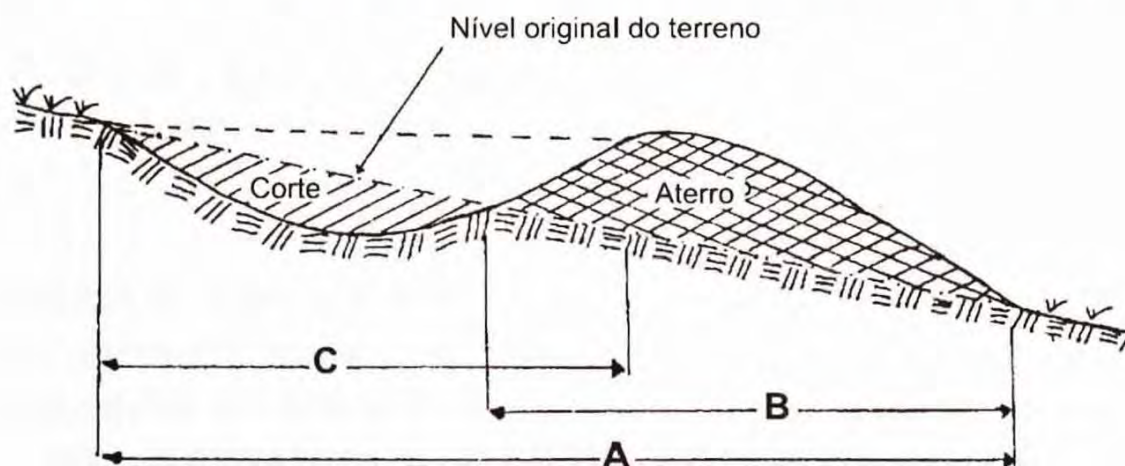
Visão esquemática de perfil do terraço indicando a secção do canal ou corte (dimensão C), do camalhão ou aterro (dimensão B) e do terraço (dimensão A).
